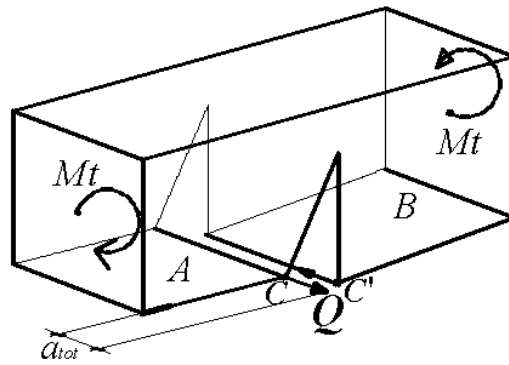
Схема железобетонного элемента с нормальной трещиной, подверженного кручению
